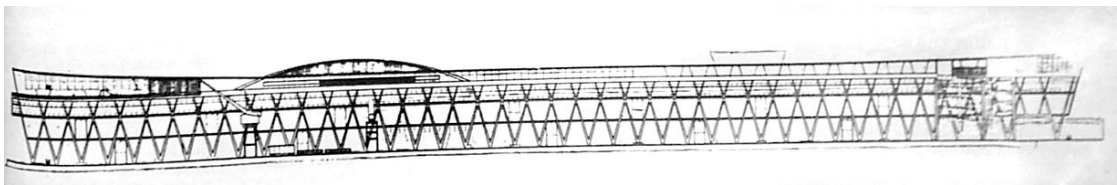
Elevação lateral com extensão de 420m. Fonte: Revista Habitat, 1955.
